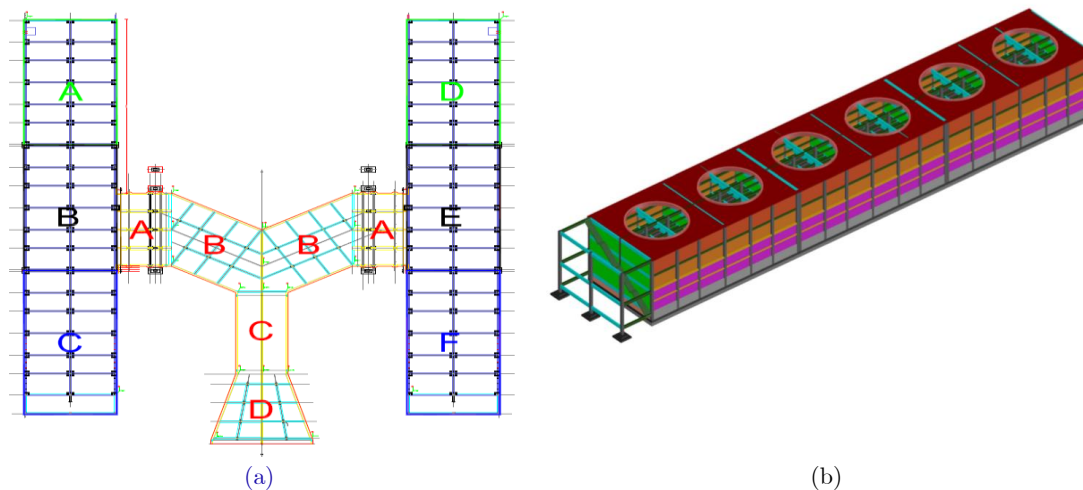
(a) Modelo 2D em planta para as torres de arrefecimento e Culvert da CCC do Soyo; (b) Modelo em 3D da torre de arrefecimento da CCC do Soyo.
